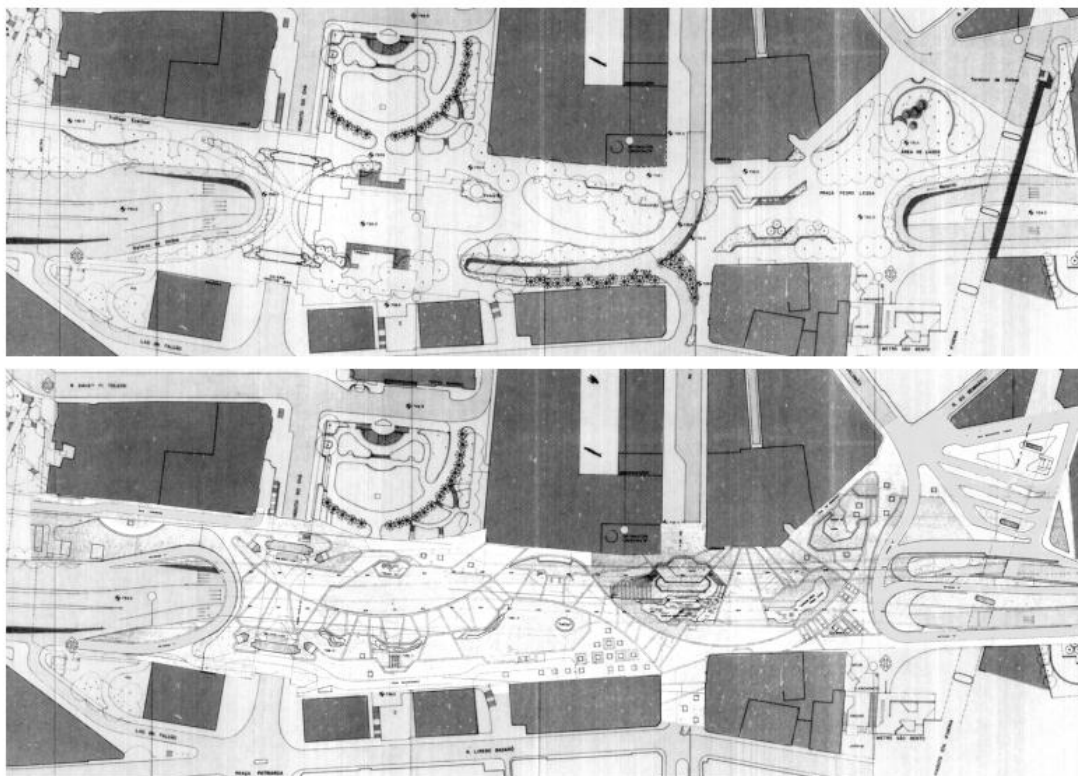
Pormenor da planta geral do projeto vencedor e pormenor da planta do projeto executado (modificação realizada pela equipe vencedora do concurso). Percebe-se que a alça de acesso do túnel à Avenida São João foi eliminada e, em seu lugar, está a Praça do Café. [Arquivo EMURB in HEREÑÚ, 2007 p. 328].
